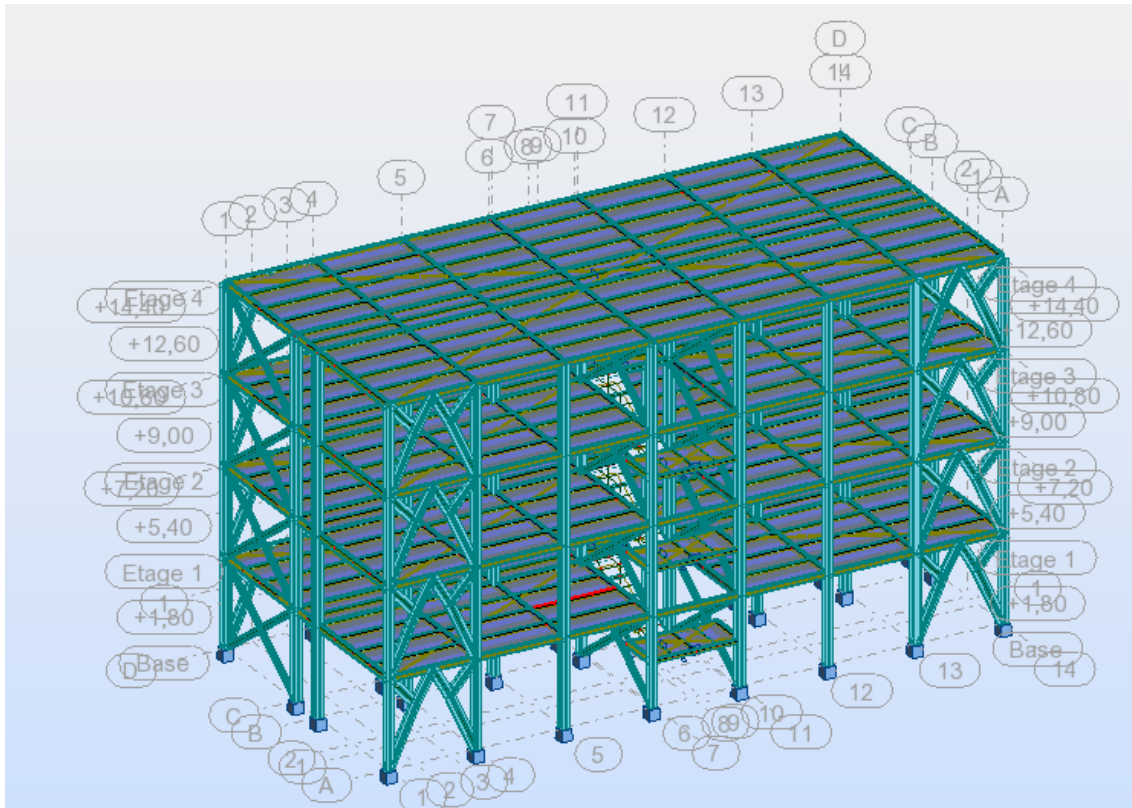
la poutre secondaire la plus sollicitée.
